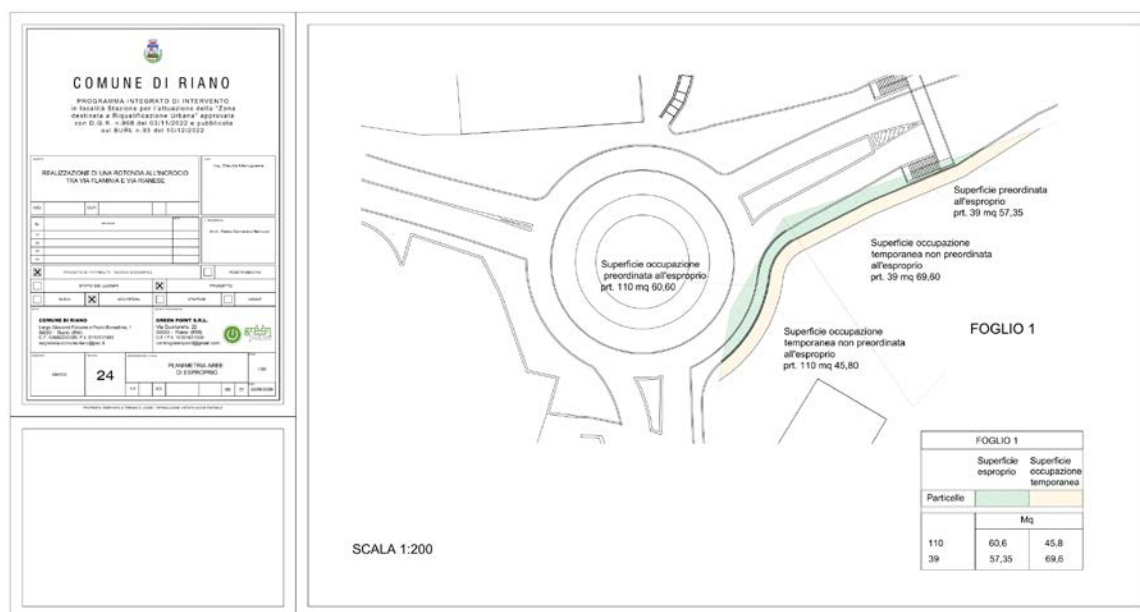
Planimetria aree di esproprio e occupazione temporanea, elaborato C24/C25.
